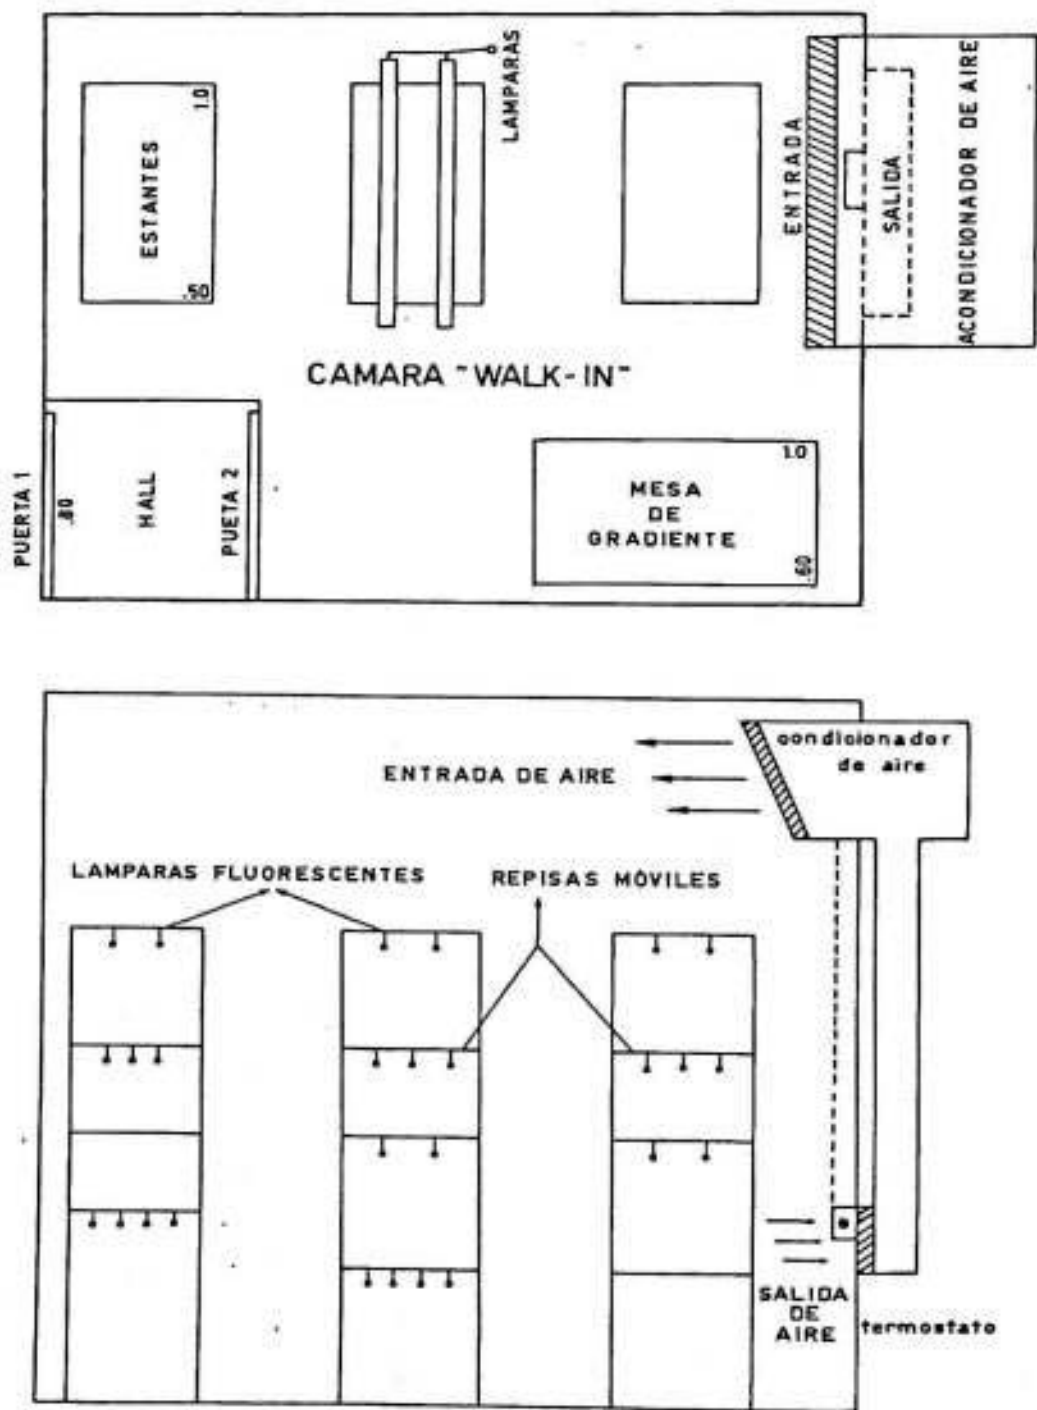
Planta de la cámara "walk in". A: planta baja. B: planta alta con vista de las estanterías y acondicionador ambiental.
